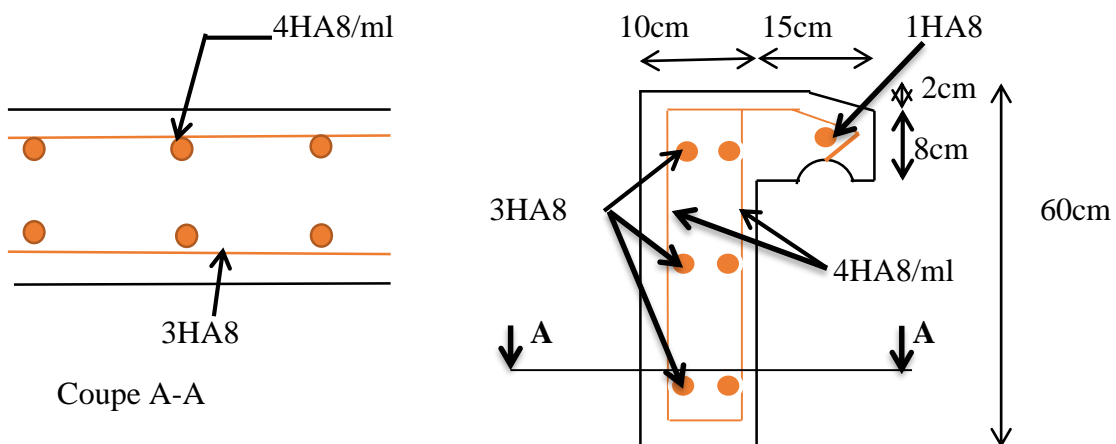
Schéma de ferrailage de l'acrotère.
